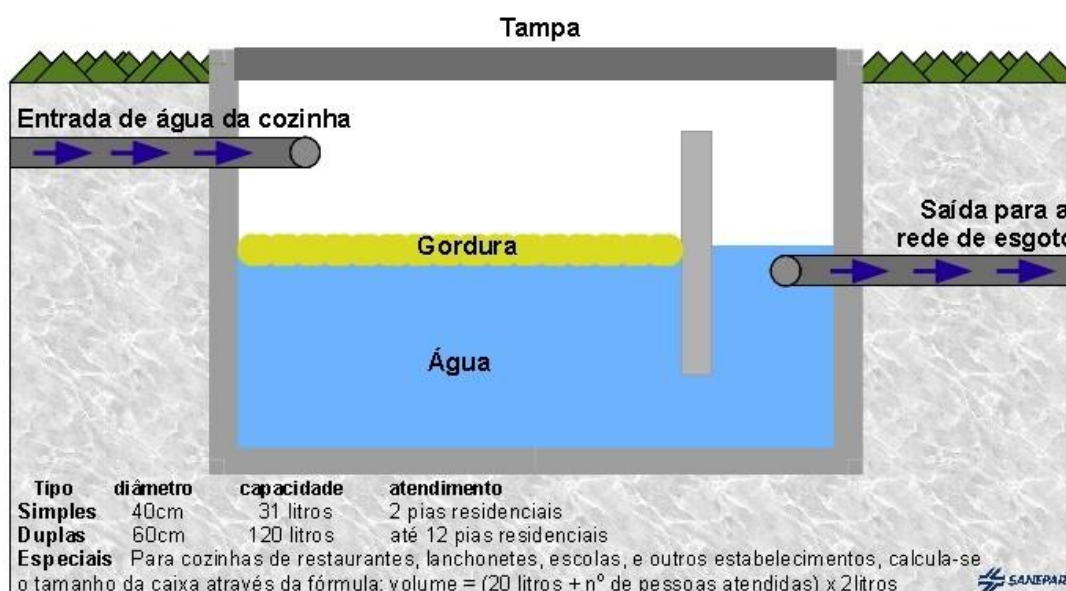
Desenho Técnico Caixa de Gordura Construída na Obra; Fonte: Sanepar
